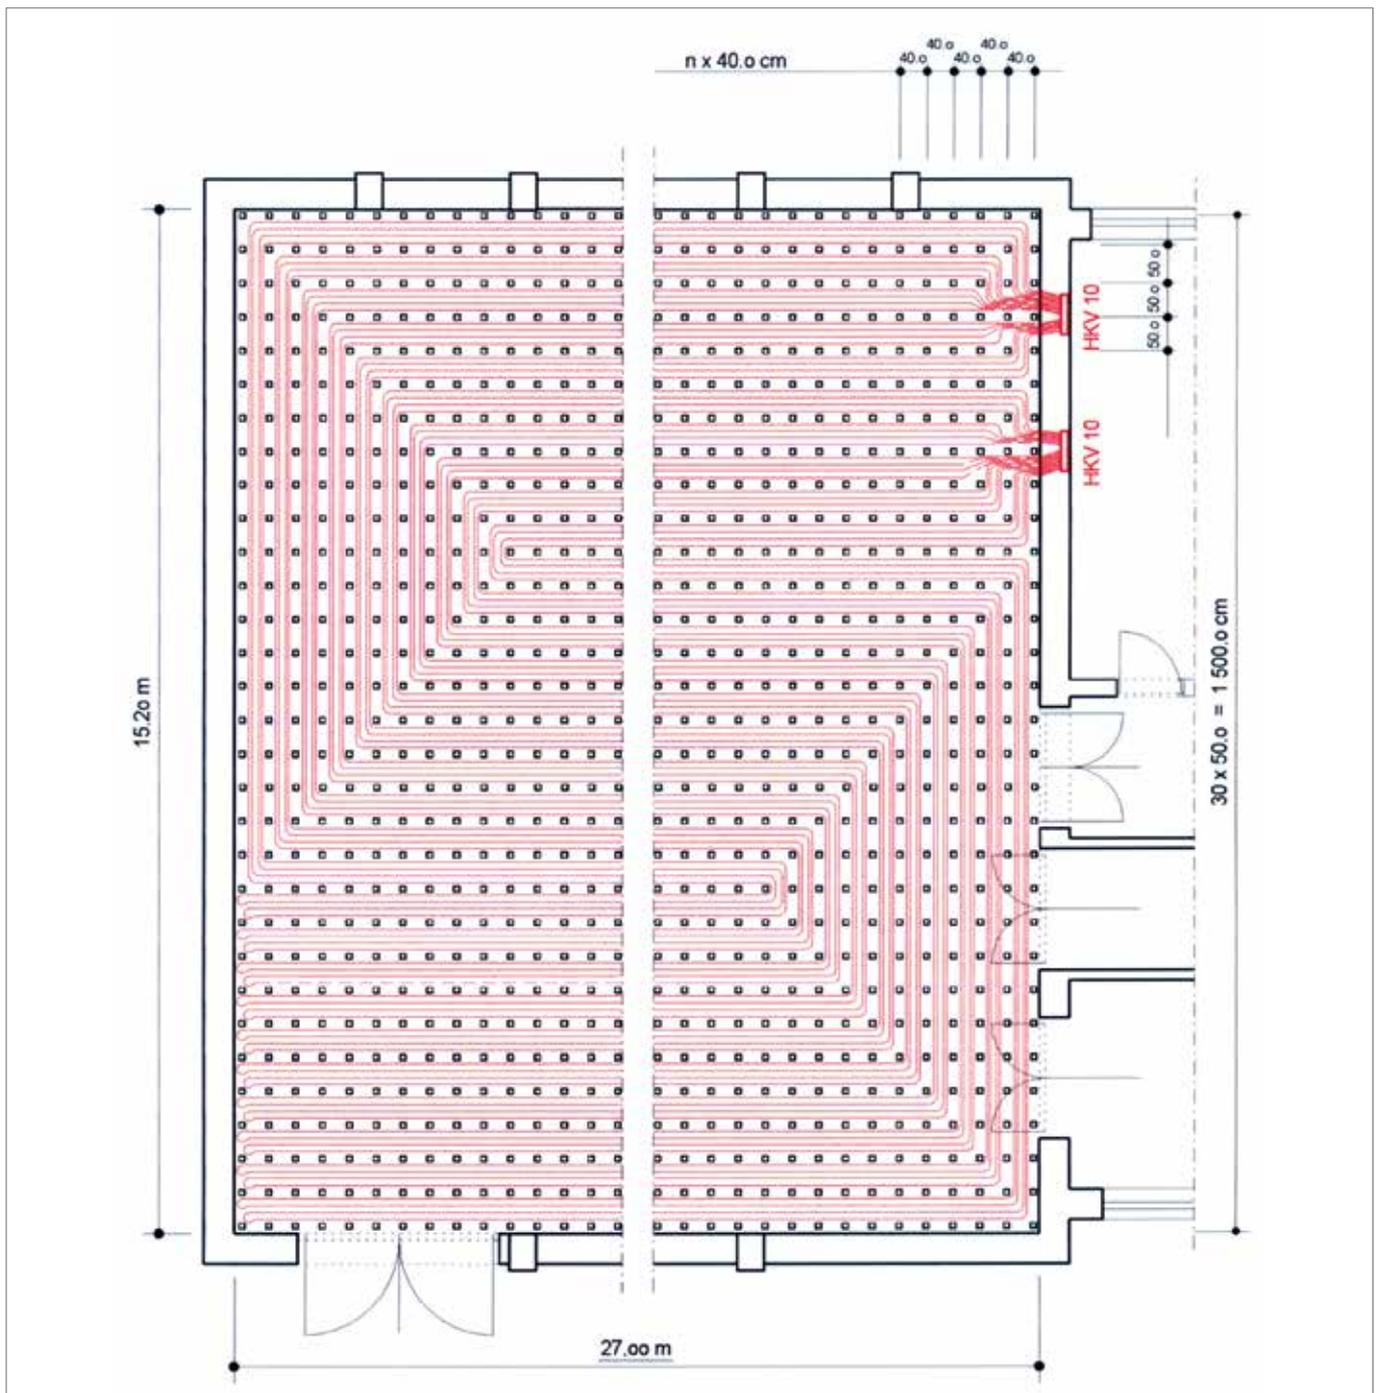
Rappresentazione schematica per il riscaldamento di pavimenti flettenti con collettore standard
